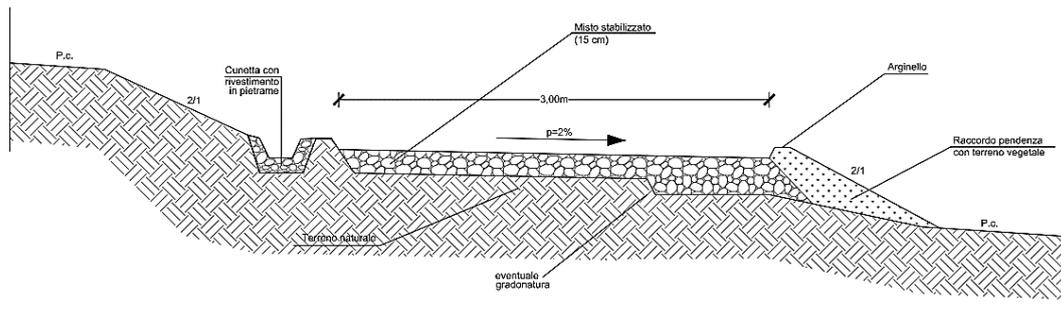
Sezione tipo strade interne al sito, tipologia a mezza costa (Fonte: ns elaborazione)
